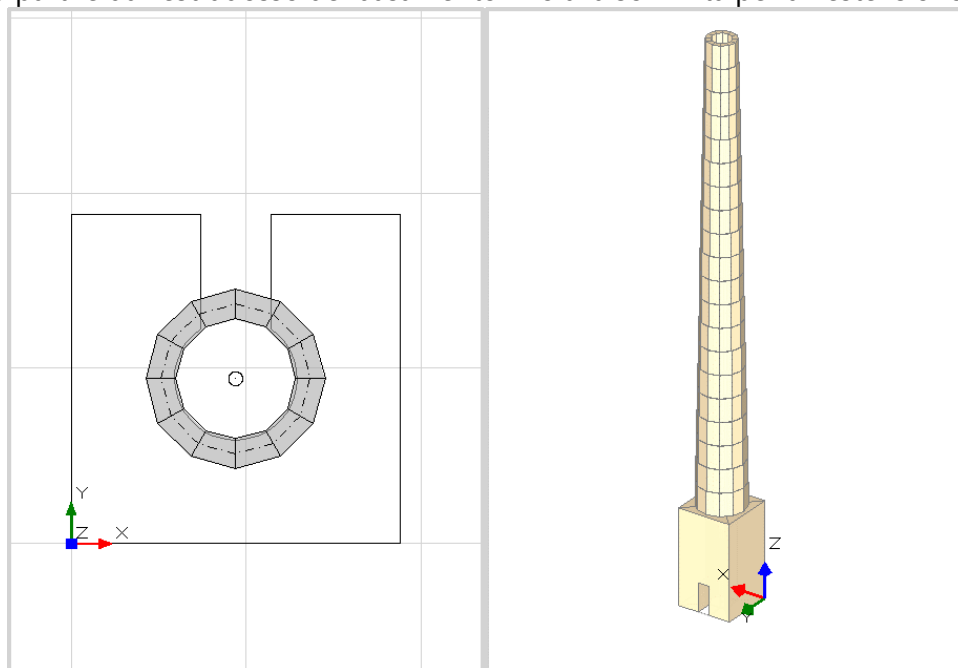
Ciminiera: vista in Pianta ed Assonometria
